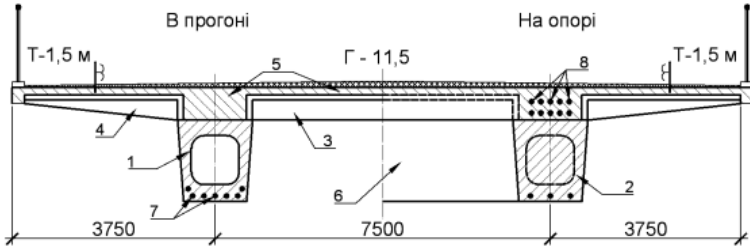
Двобалкова нерозрізна збірно-монолітна залізобетонна прогонова будова моста для складних умов будівництва: 1 - збірна прогонова балка; 2 - монолітна або збірна надопорна балка; 3 - збірна ребриста плита; 4 - збірна ребриста консольна плита; 5 - бетон замонолічування головних балок і плити; 6 - монолітна діафрагма в стиках і над опорами; 7 - напружувана арматура збірних балок; 8 - напружувана арматура в надопорних зонах і стиках
